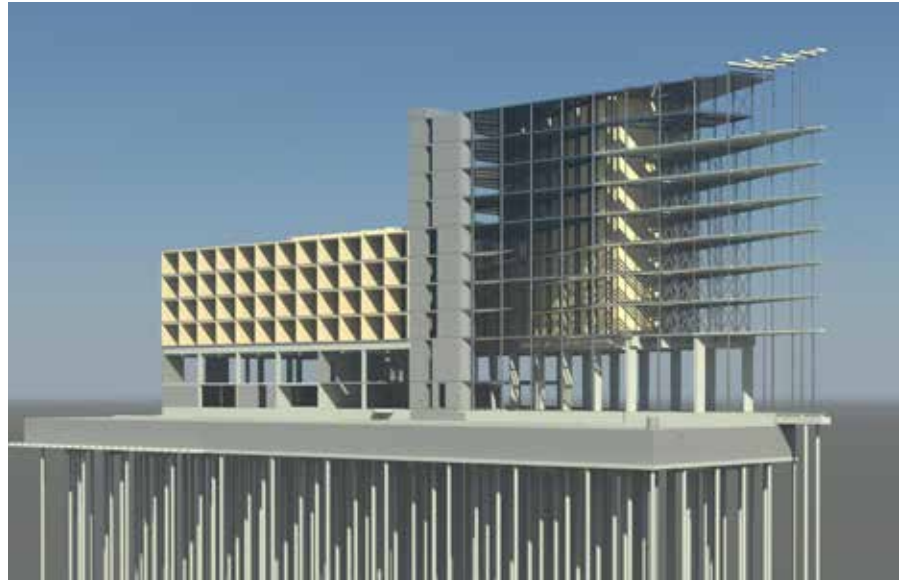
Auf ein gestaffeltes Stahlbeton-Sockelgeschoss setzen der Stahlbeton-Skelettbau und die Raummodule auf. Der Erschließungsturm bildet das statische Rückgrat des Neugeschossers. (Bildquelle: Pieters Bouwtechniek)
